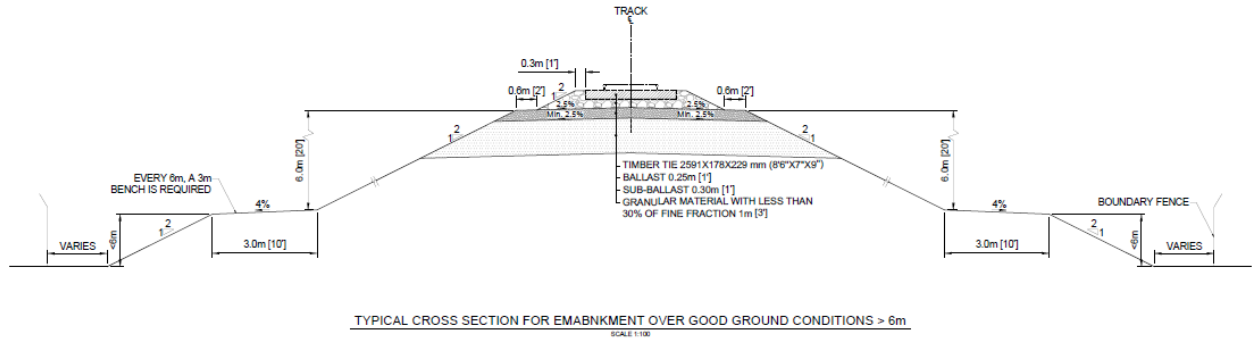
Coupe transversale typique des travaux de terrassement
